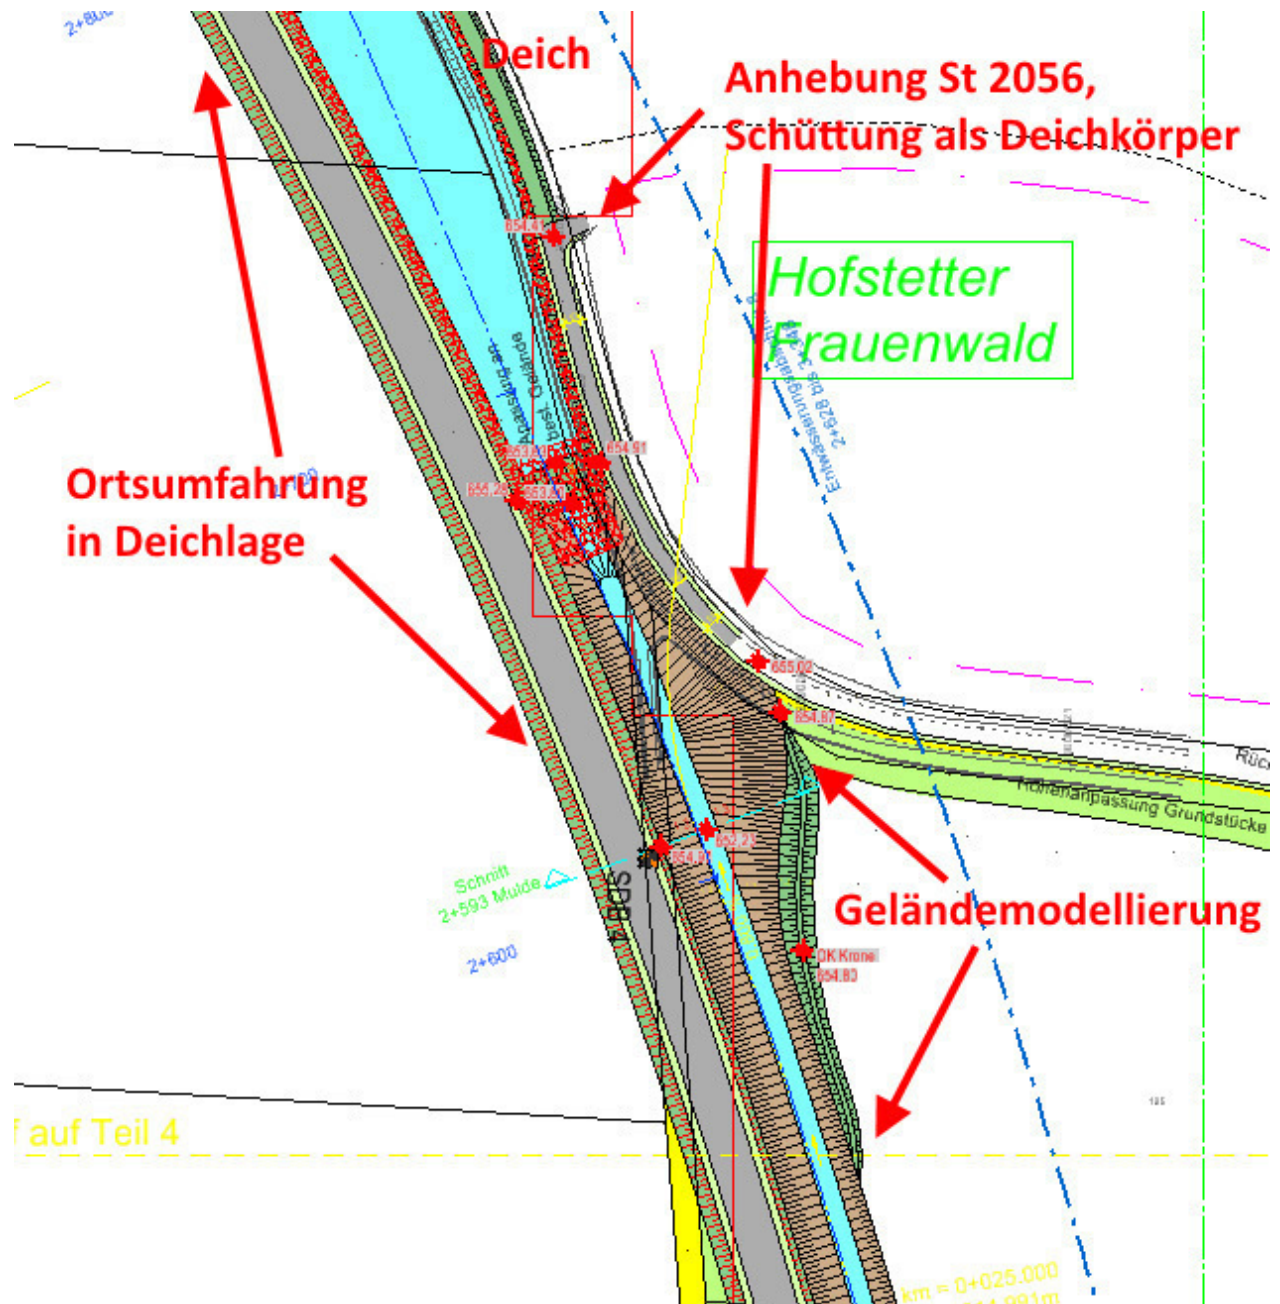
Lageplanausschnitt (Unterlage 18B 2.5) Maßnahmen im Bereich des Hofstetter Frauenwaldes
